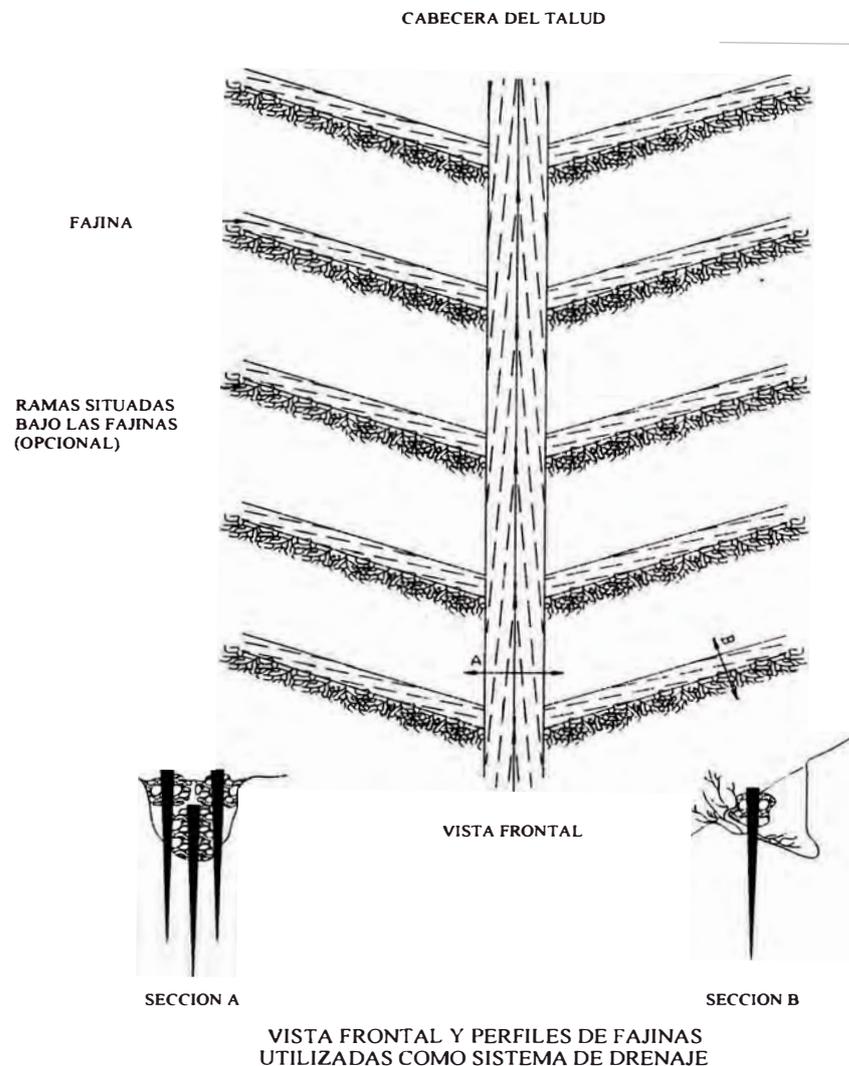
Vista frontal y perfiles de fajinas utilizadas como sistema de drenaje.
